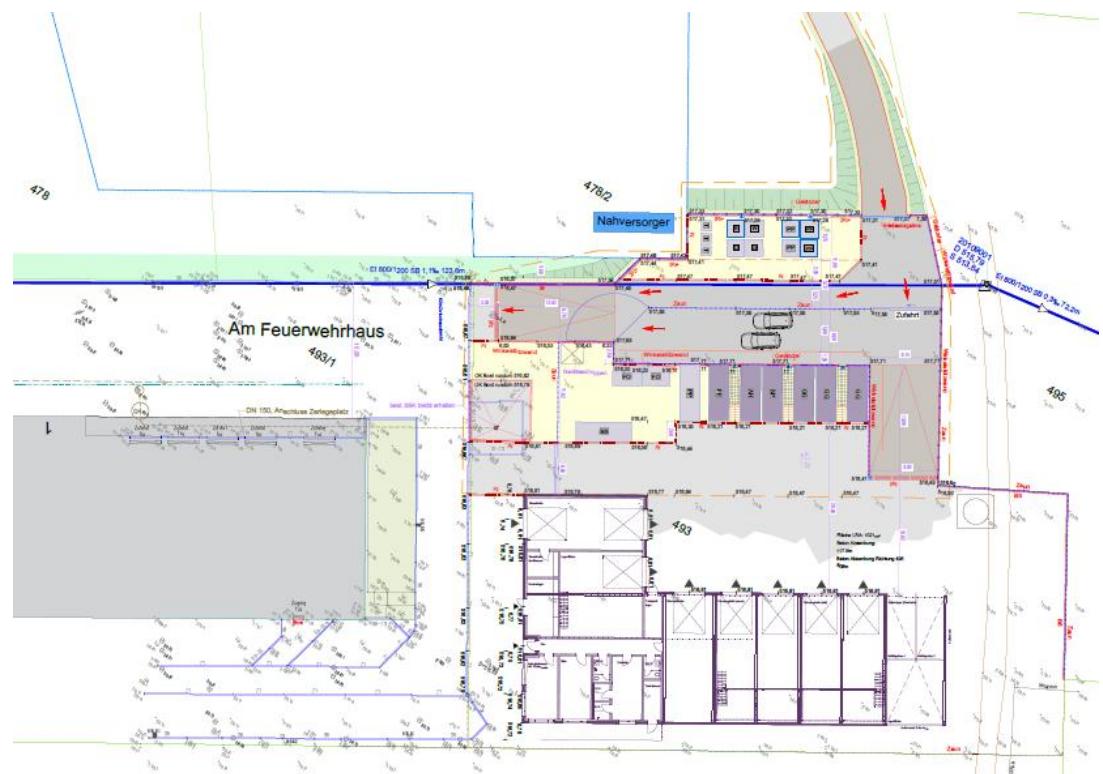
Entwurfsplanung Recycling- und Bauhof, ohne Maßstab, Ingenieur- und Planungsbüro Wunderlich GbR, 15.10.2025
